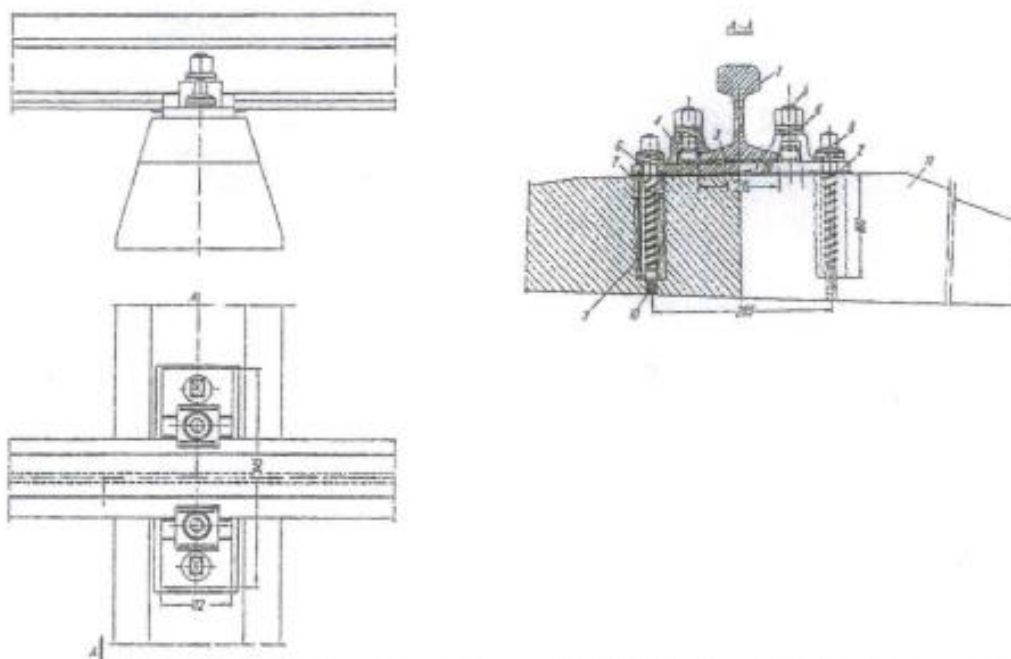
Przytwierdzenie typu SB szyny UIC60(60E1) do podkładów betonowych
